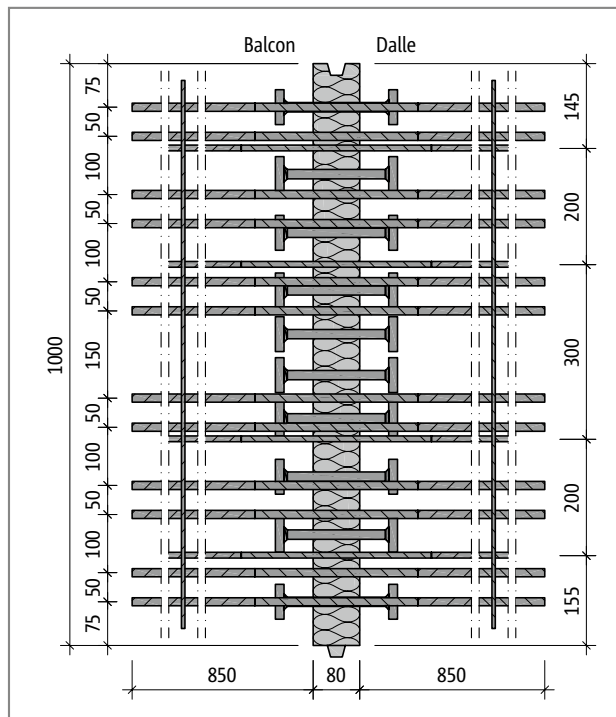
Schöck Isokorb® T Type K-M12-V1 : Plan de base du produit
